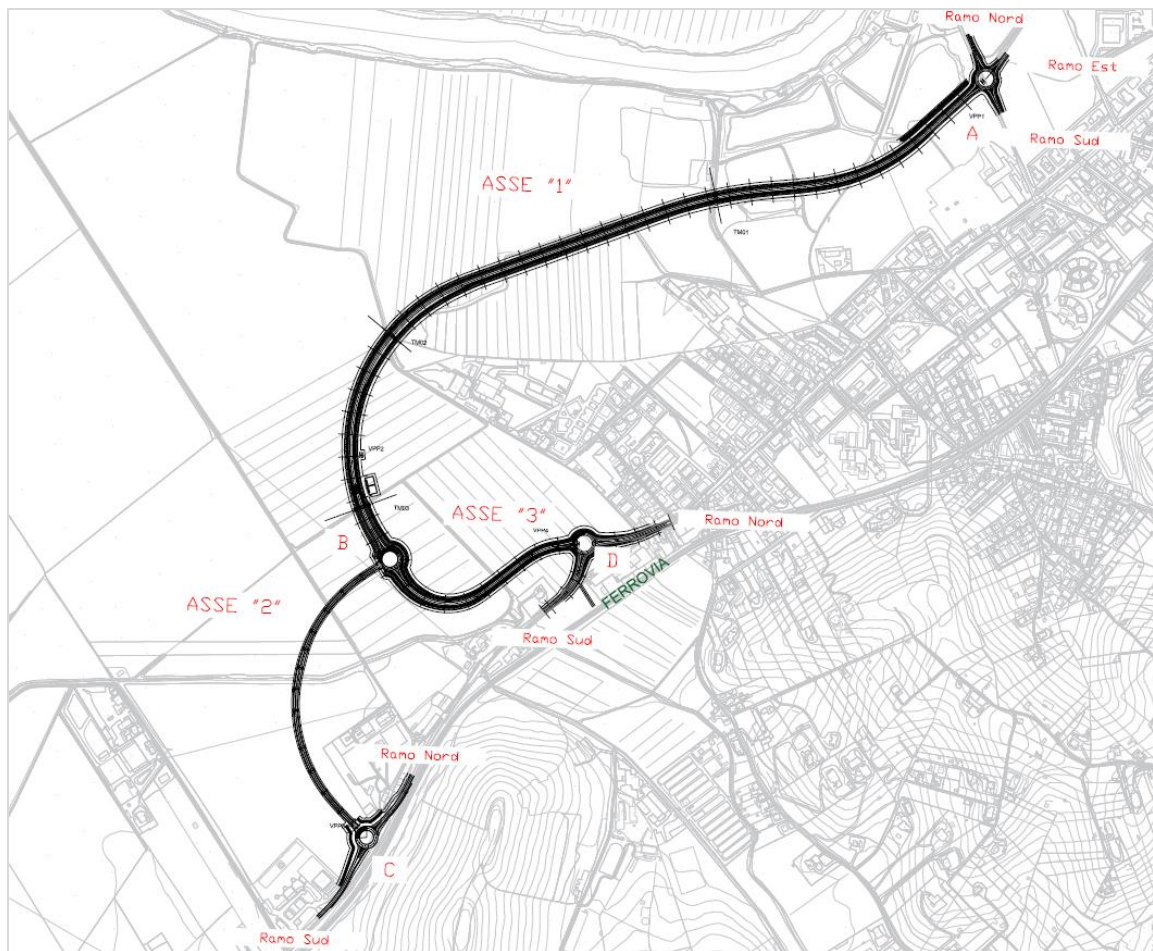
Planimetria dell’area di intervento e del tracciato di progetto.
